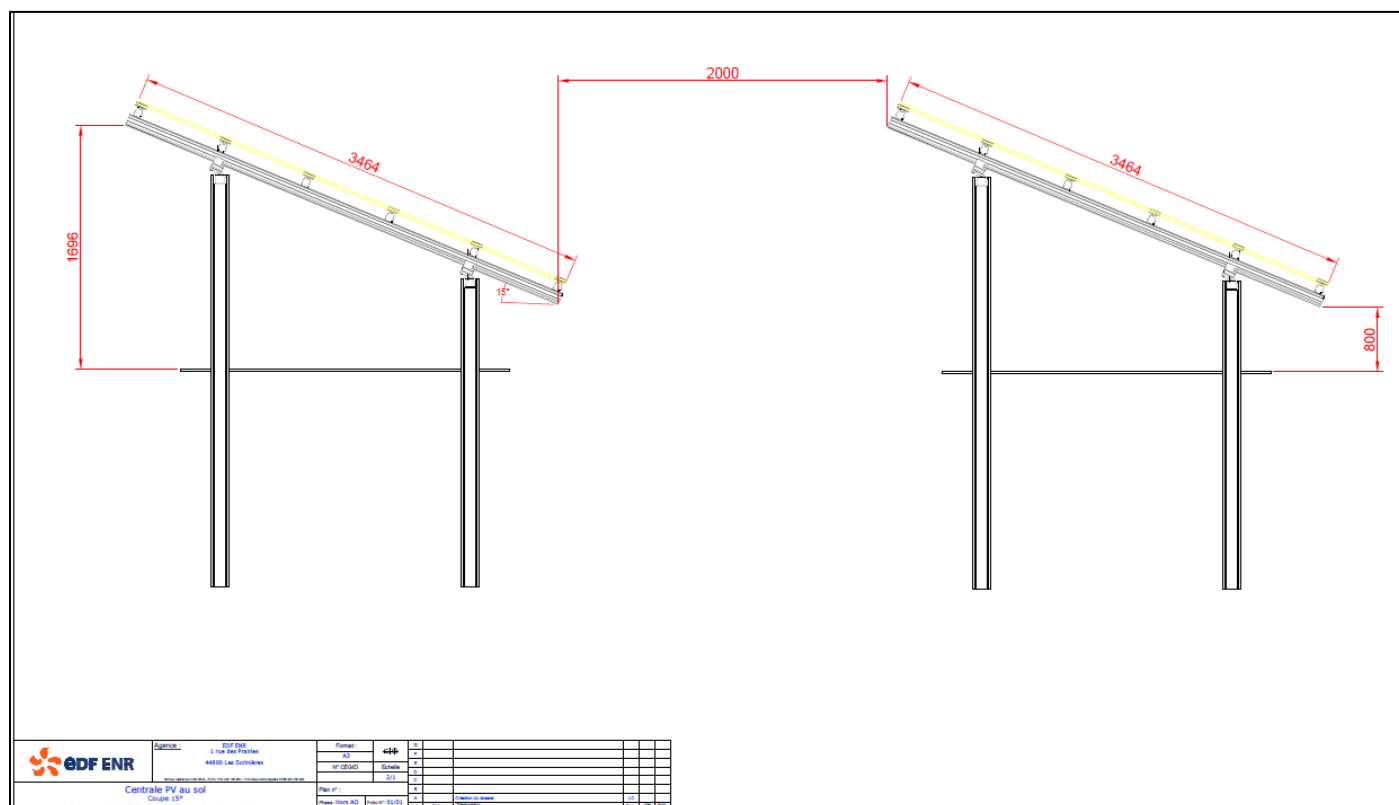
Coupe de structure des panneaux photovoltaïques (source : EDF-ENR)
